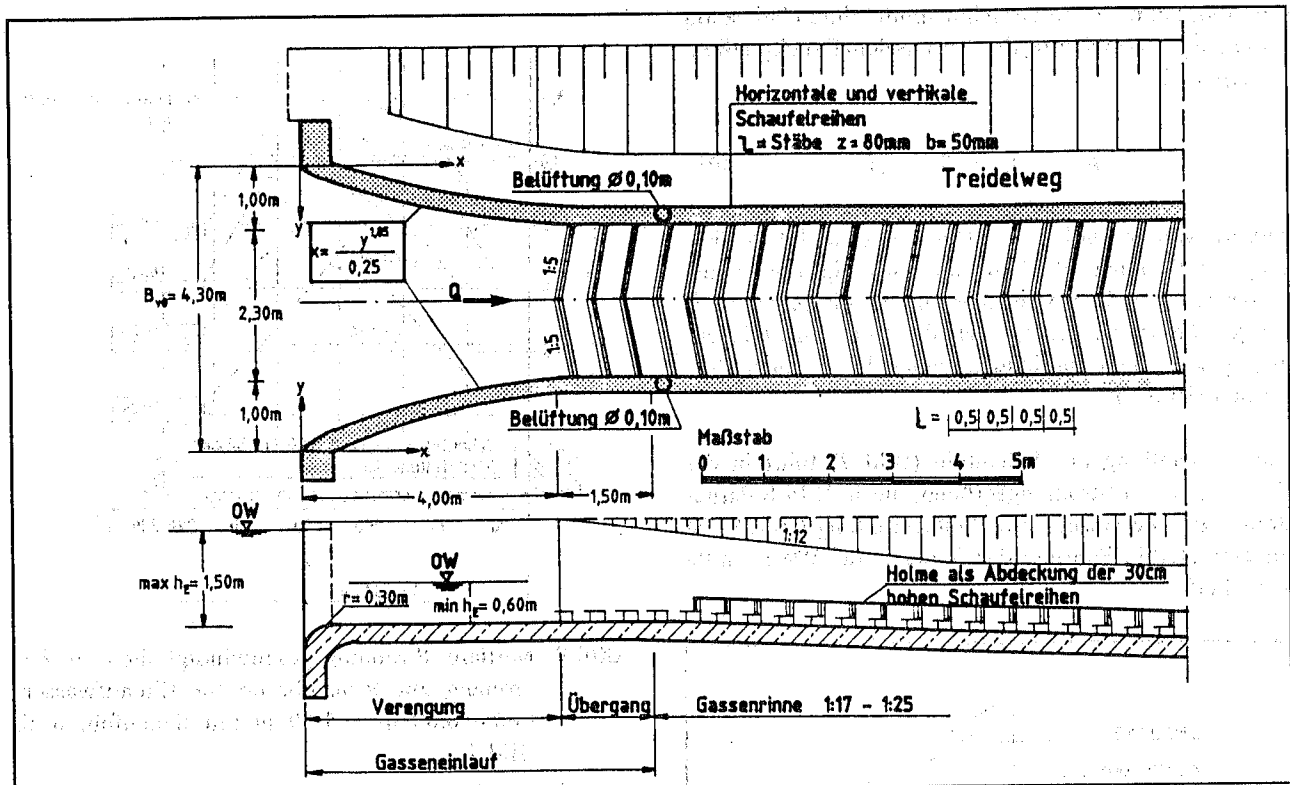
Ausführungsvorschlag für einen Bootsgasseneinlauf
